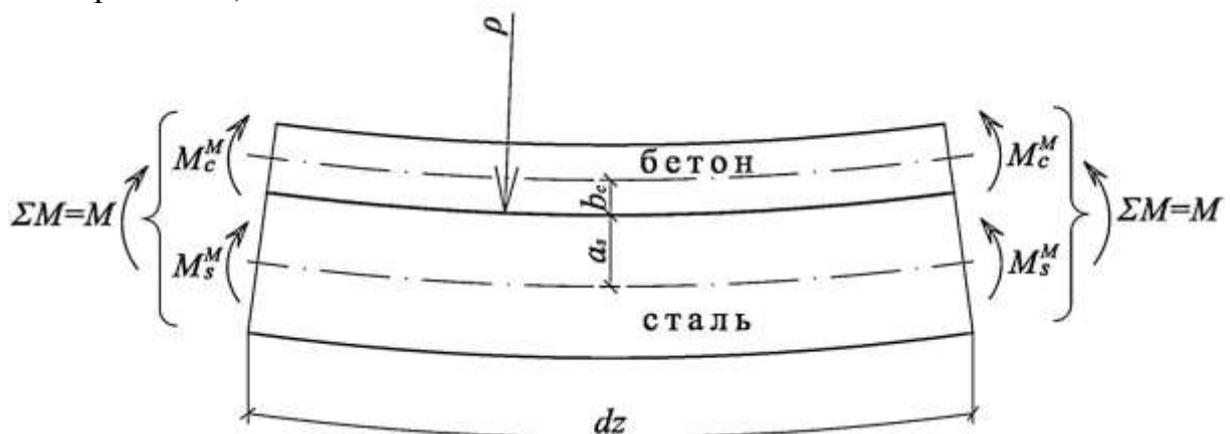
До визначення частин згинальних моментів від дії зовнішнього навантаження, що сприймаються окремо кожним шаром сталезалізобетонної балки
